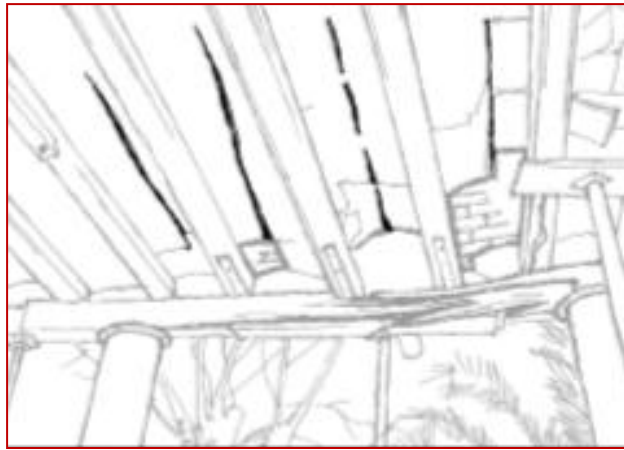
Exemples des fissurations au niveau de plancher
